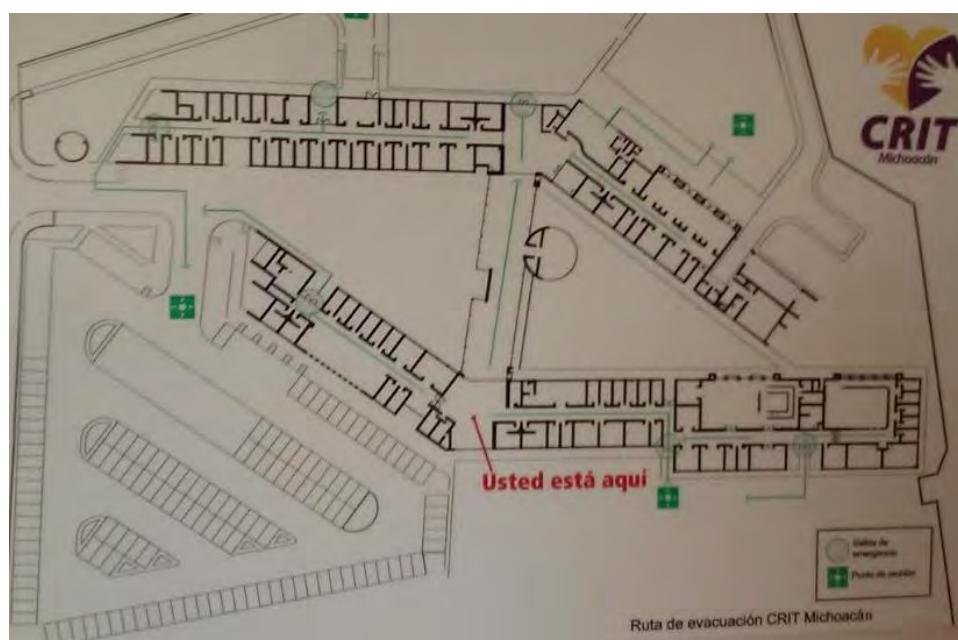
Planta Arquitectónica CRIT. Fotografía tomada por la autora.
